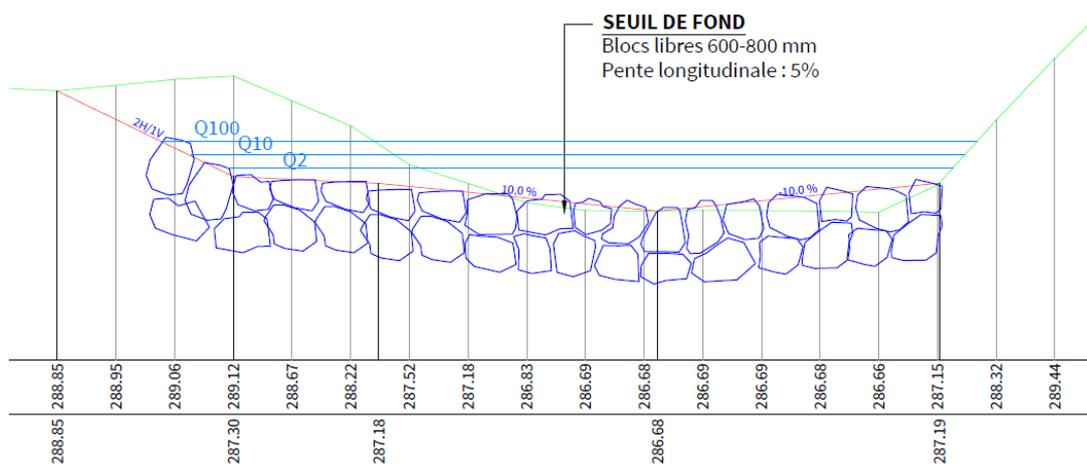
Coupe en travers de la rampe rugueuse aval - PT21 - (échelle non précisée - cf. annexe2: cahier de plans)
